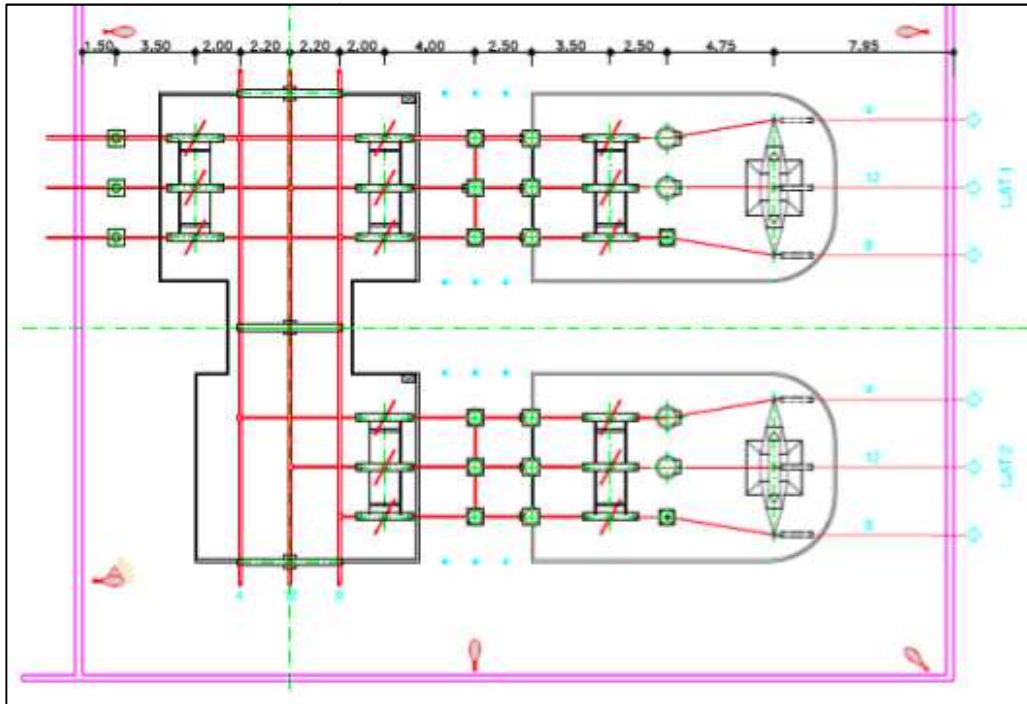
Esempio stalli in Stazione Elettrica in entra-esce sulla linea RTN - Pianta
